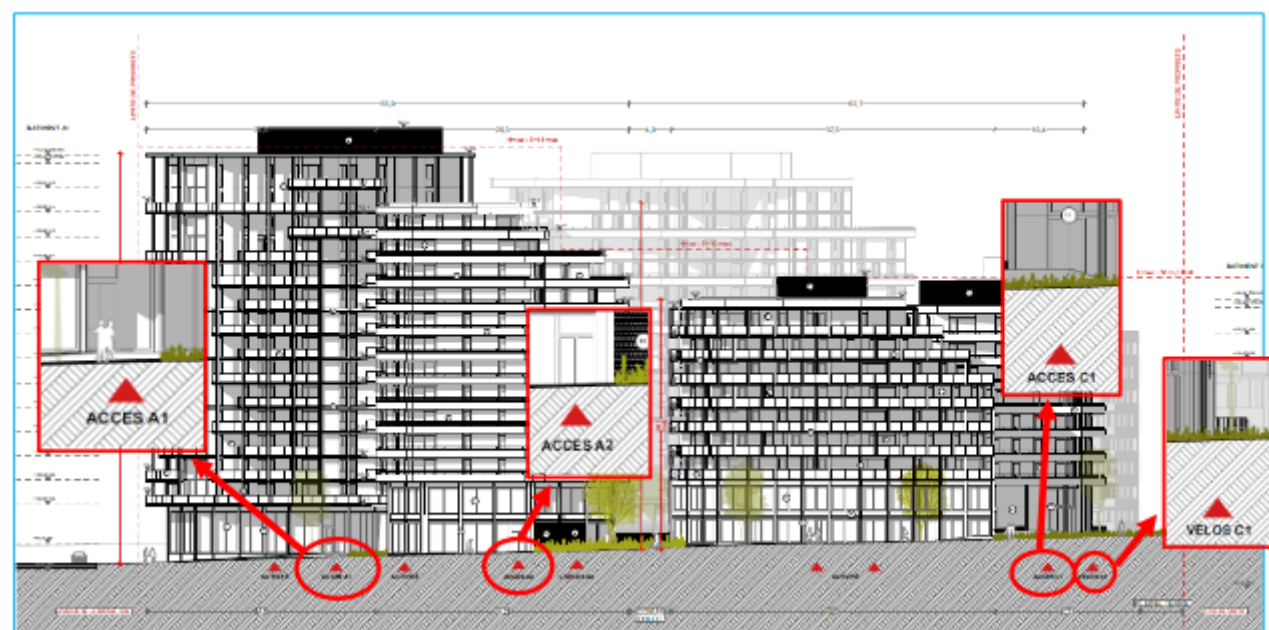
Coupe longitudinale de la façade de l'Avenue de la République (Source : PPX Architecture)
